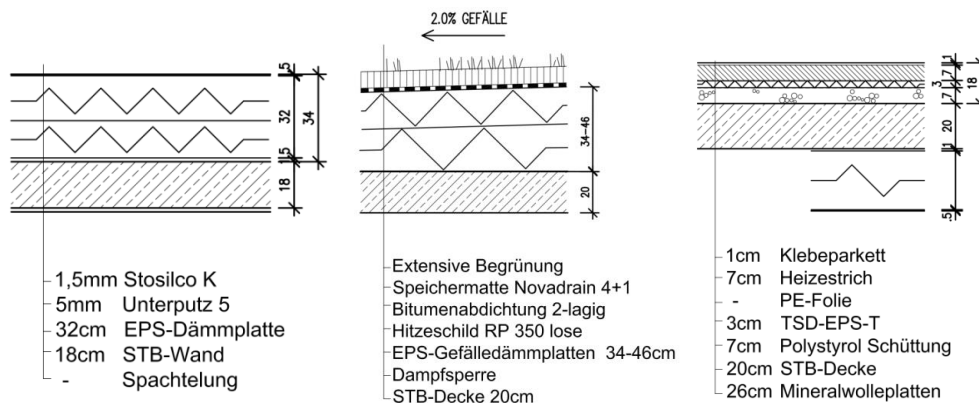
Aufbauten der Gebäudehülle – Links: Außenwandaufbau; Mitte: Dachaufbau; Rechts: Geschoßdecke zu unkonditioniertem Untergeschoß, aus Anhang 1-2 Aufbauten Katalog
